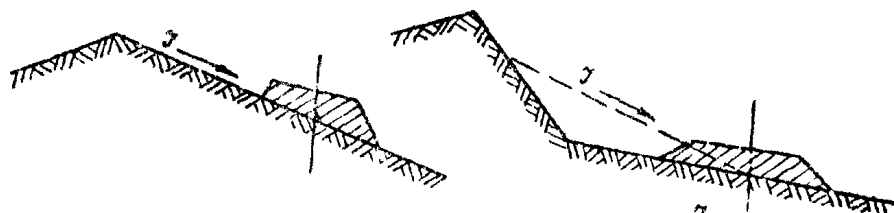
Схемы к определению расчетного уклона  $J$  в месте впадения водотока выше створа проектируемой дороги.
